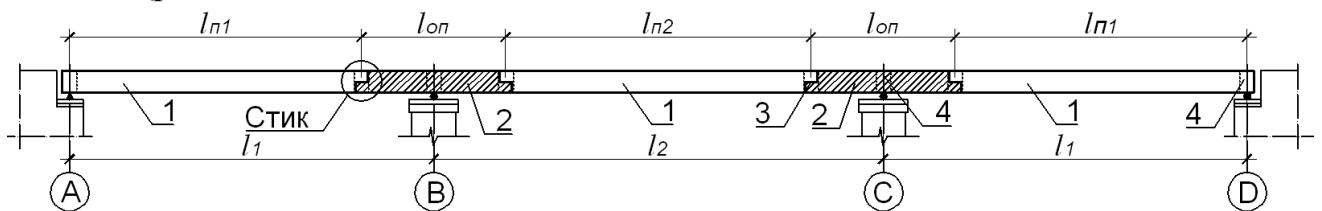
Поділ на елементи нерозрізних балок запропонованої конструкції по довжині: 1-прогонова збірна балка, 2- надпорна збірна або монолітна балка, 3-поперечна балка в зоні стику, 4-поперечна балка над опорою
